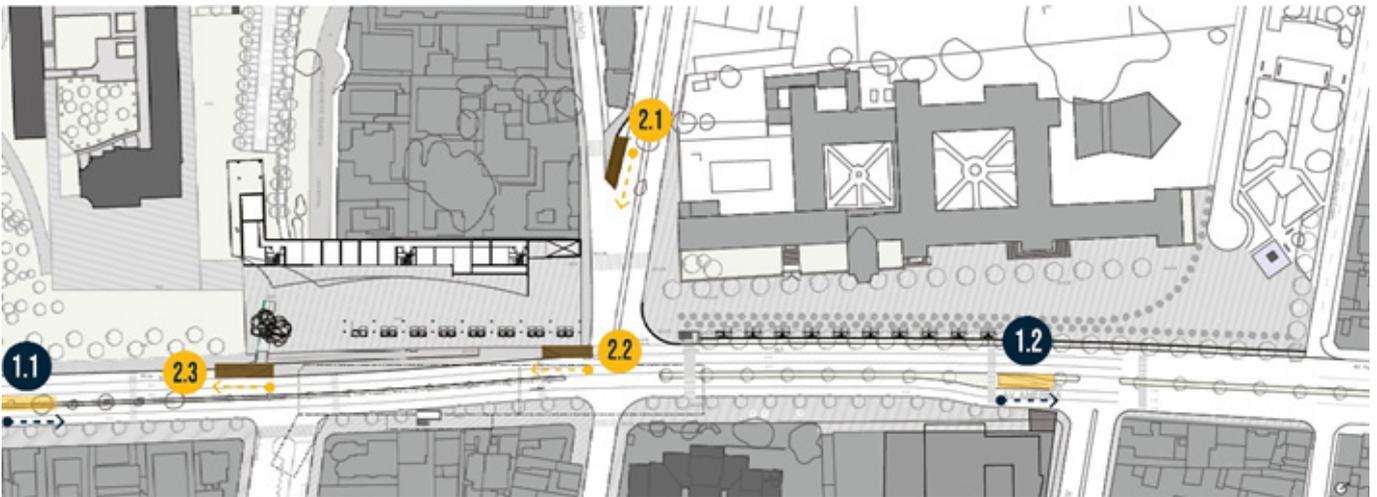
Planta de la actuación con las tres plazas. Fuente: Elaboración Propia, modificado por Pablo Santín.
